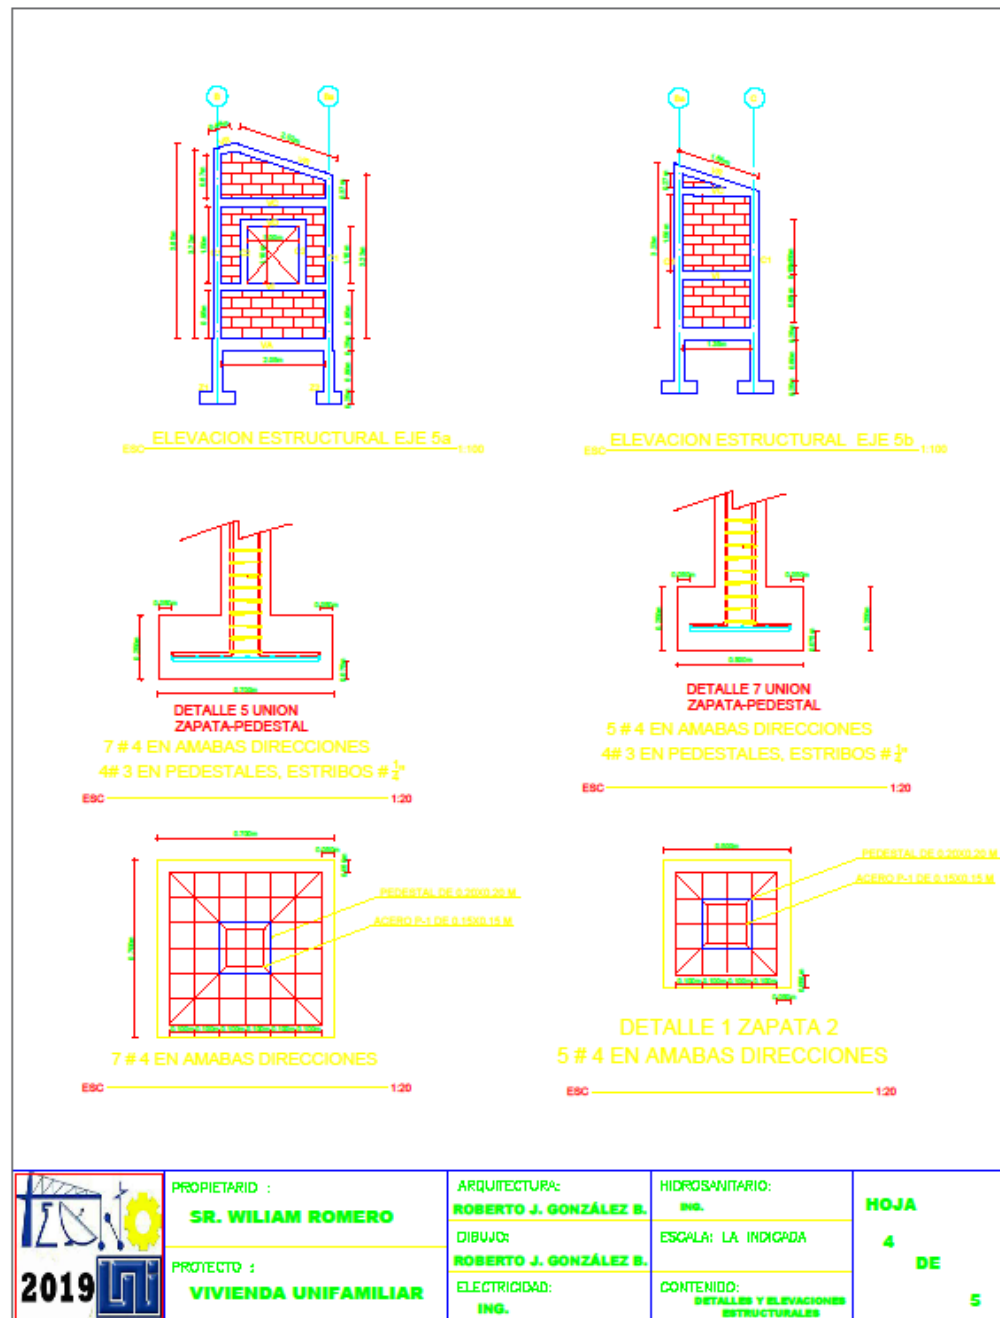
ELEVACIONES ESTRUCTURALES EJES 5A, 5B Y DETALLES
